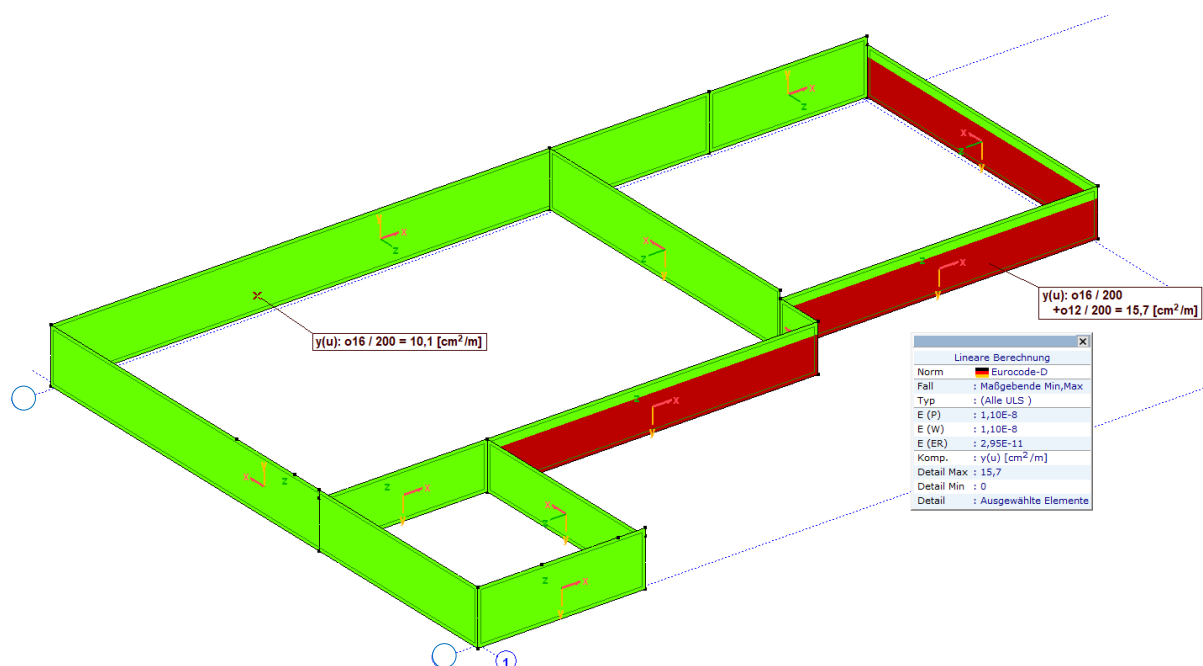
Entworfenere Bewehrung außen in lokaler y-Richtung (vertikal)
